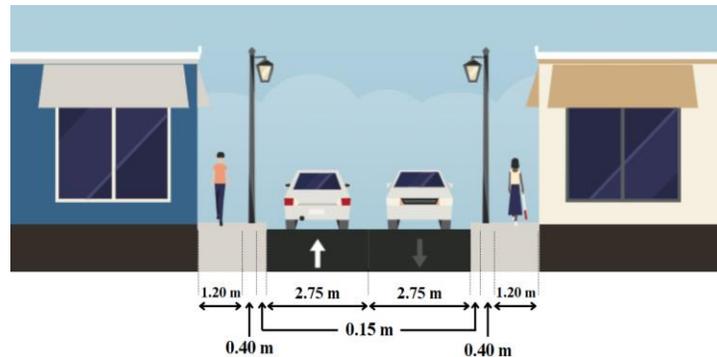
Propuesta de creación de banqueta con ancho de calzada de nueve m
